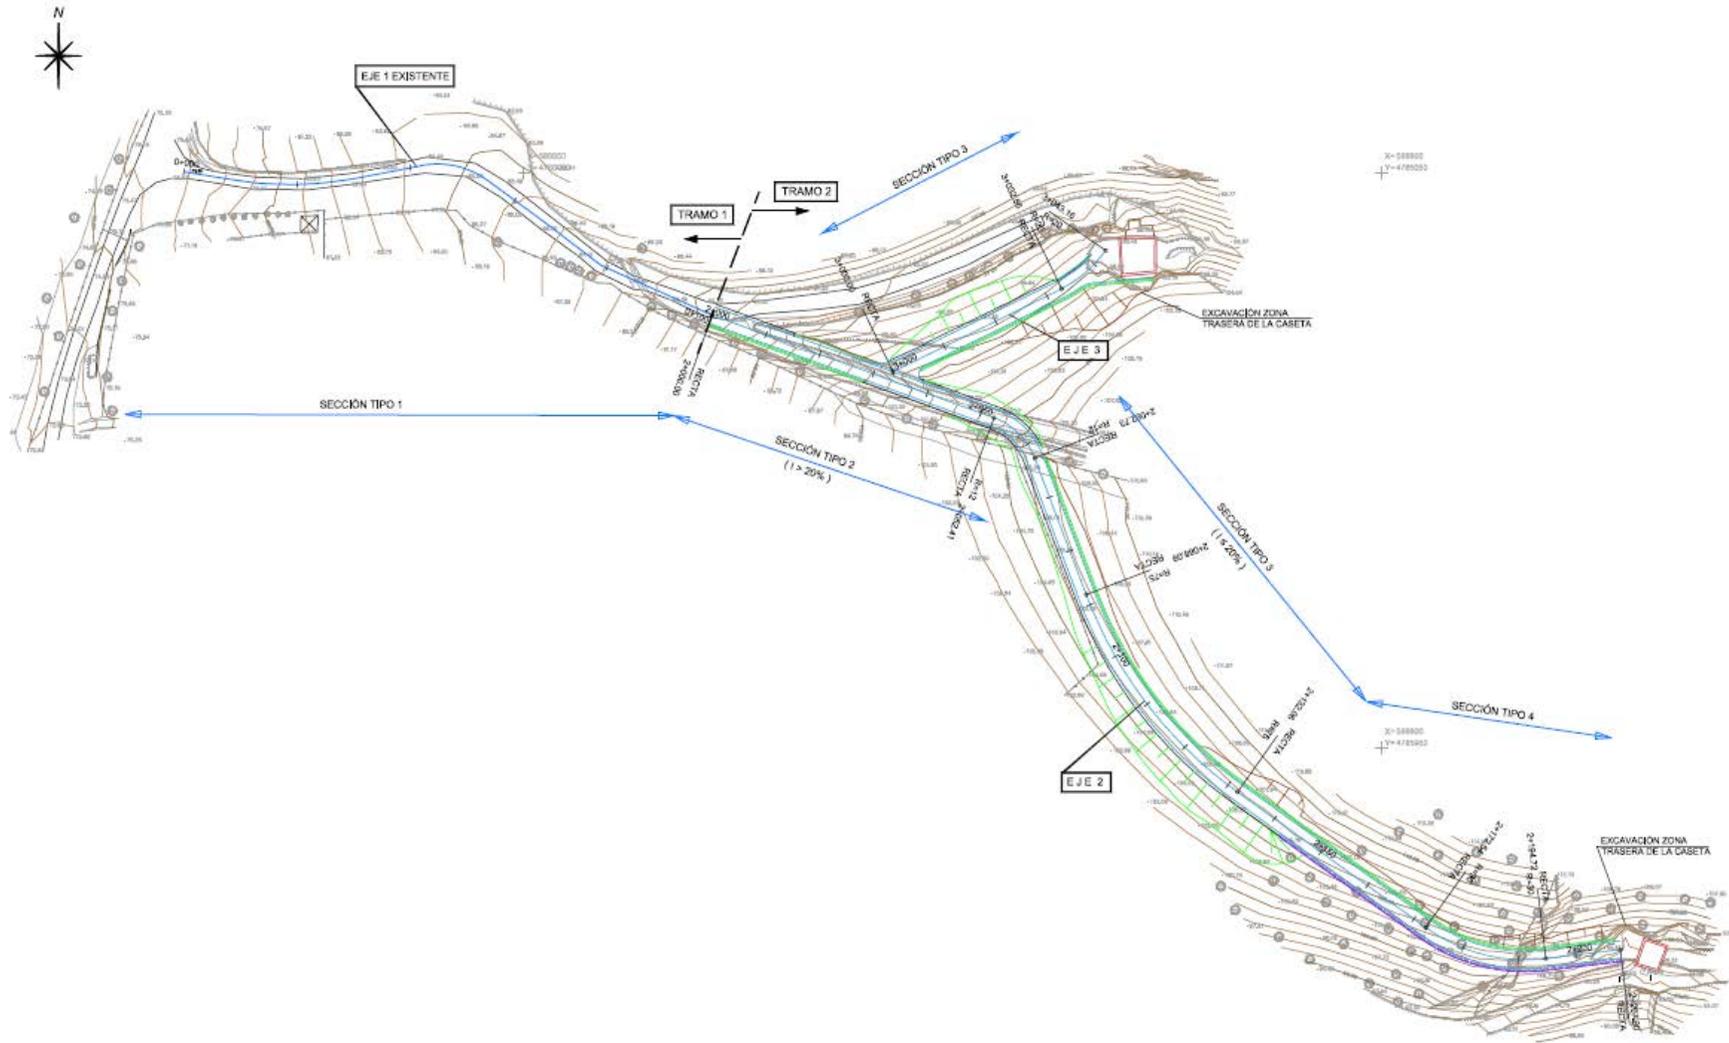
Planta de definición. Fuente: Desarrollo del Plan de Contingencia de abastecimiento en caso de rotura del Canal Bajo. caminos de acceso a las casetas 7 y 8
